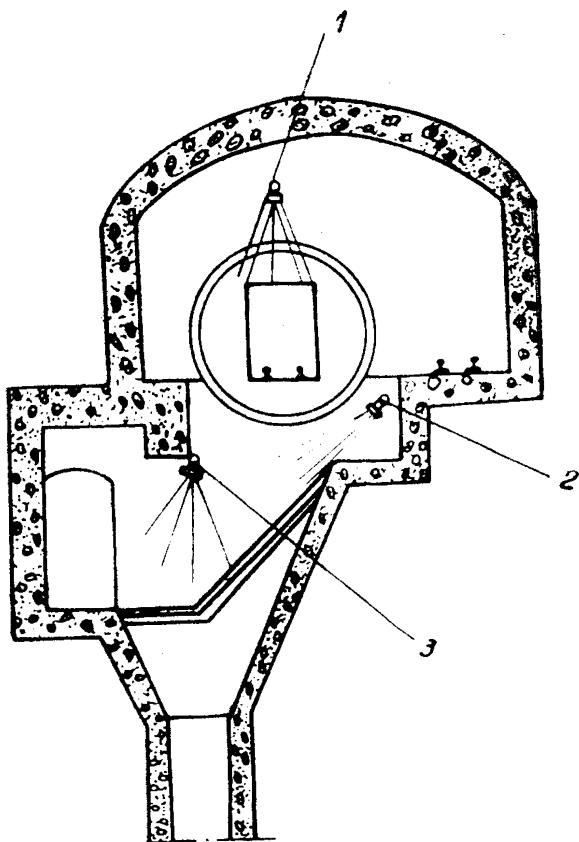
Схема установки гидрофорсунок на опрокиде подземного бункера:
